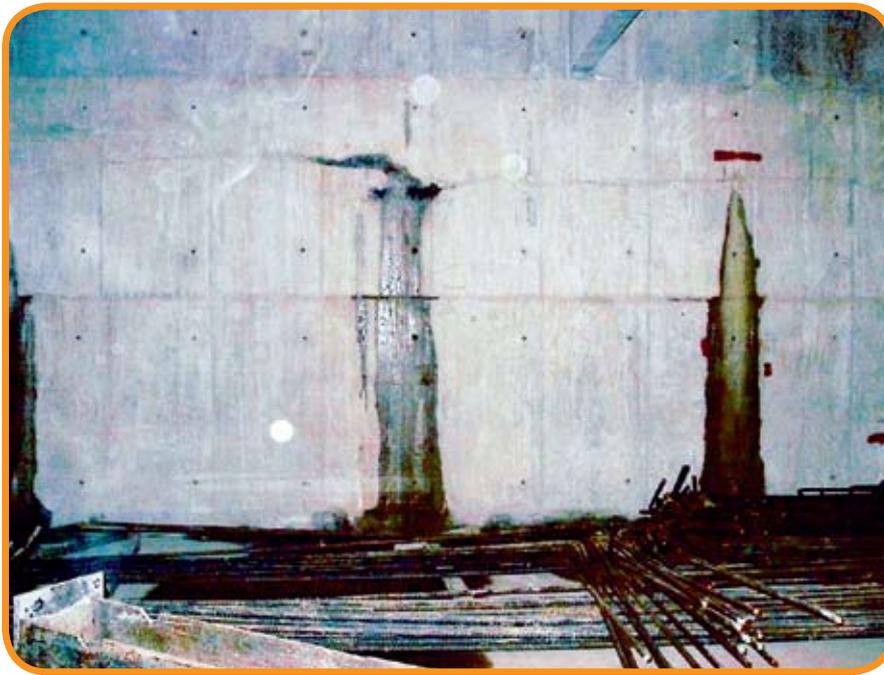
Vista da parede diafragma com infiltração por junta de concretagem
